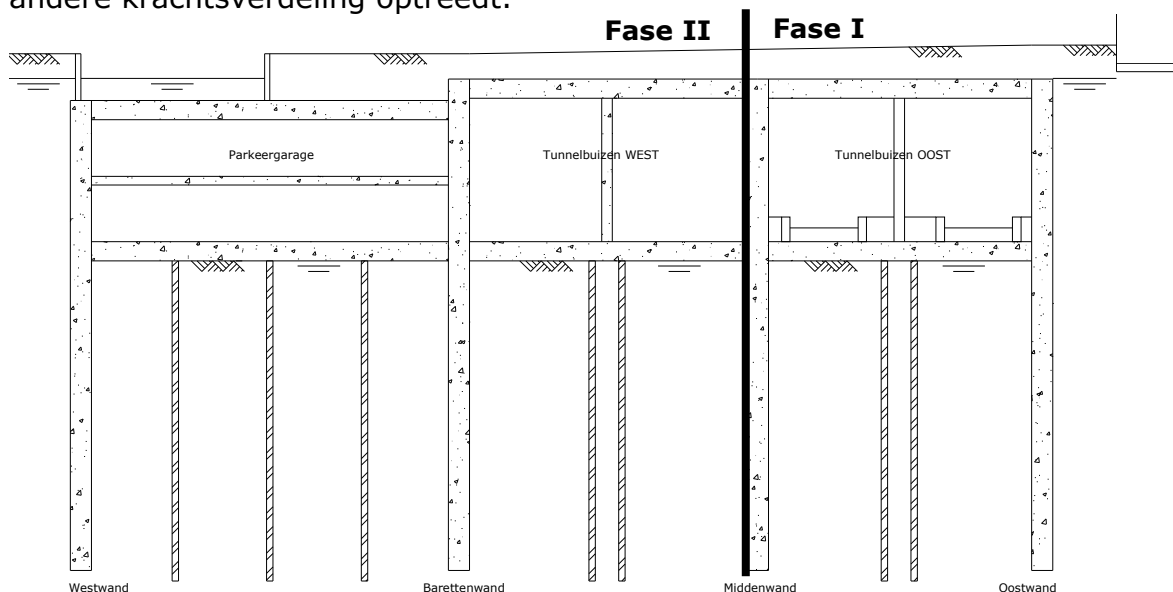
Fasering tunnelconstructie en parkeergarage
